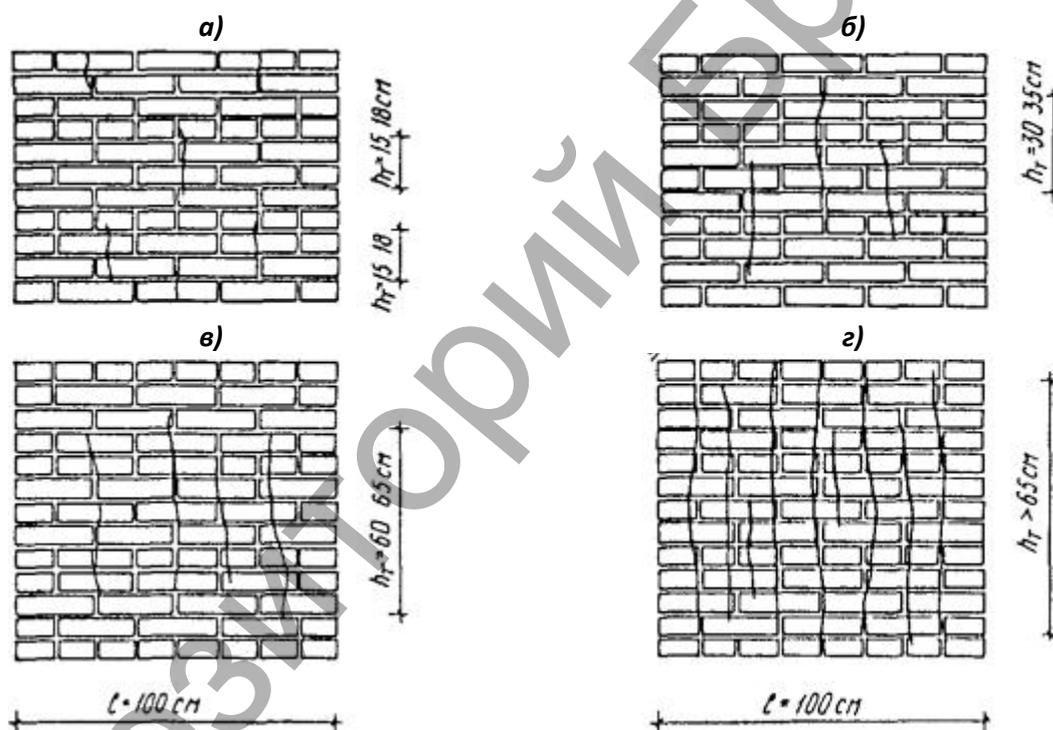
Степень повреждения вертикальными трещинами каменных и армокаменных конструкций [6]:
